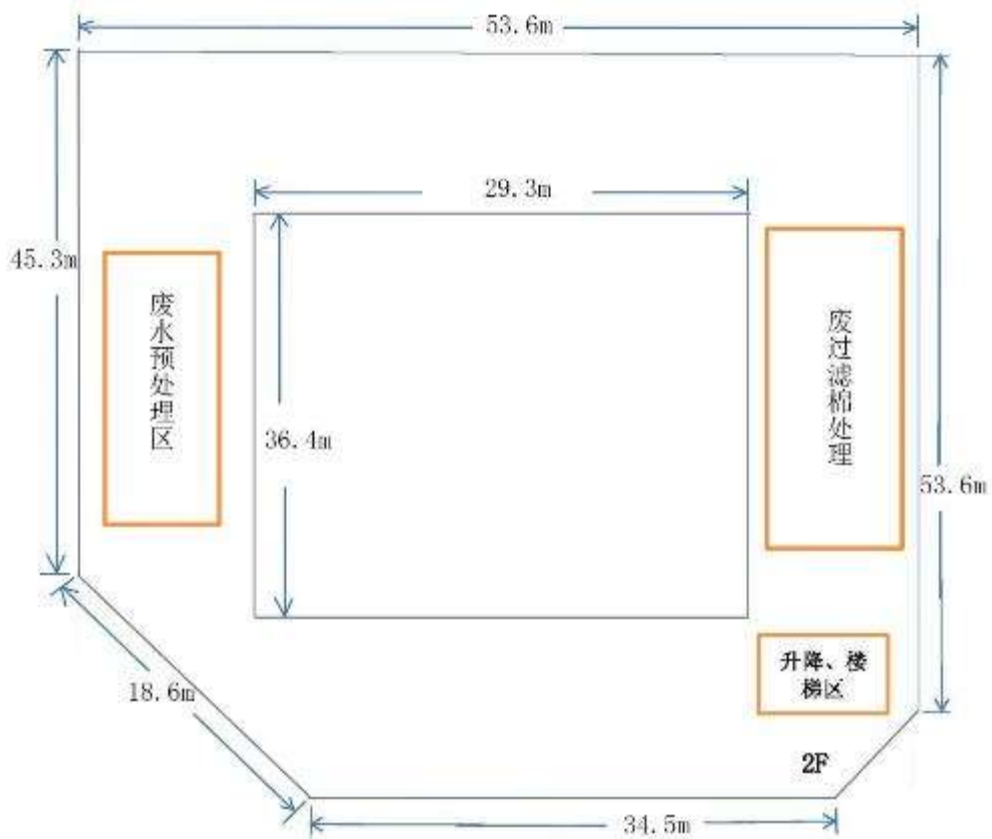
搬迁及改扩建后北厂区 2#厂房二层平面布置图
